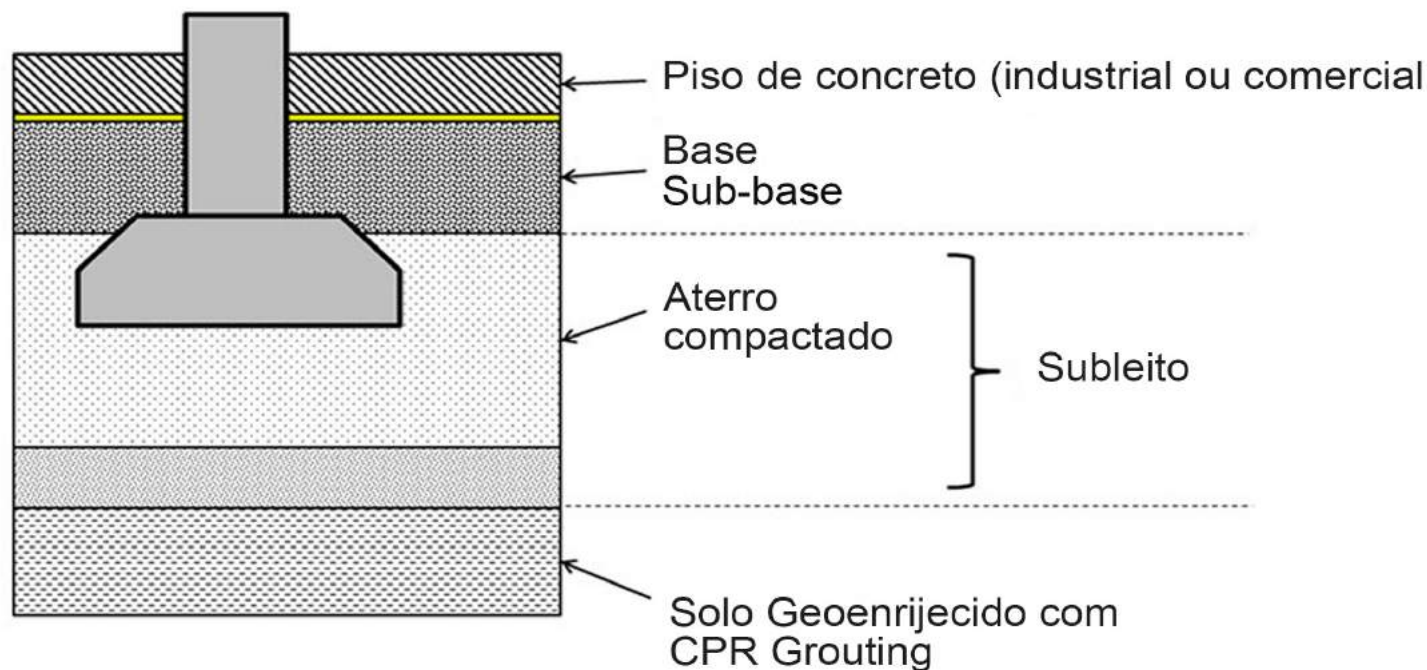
O solo mole, geoenrijecido com CPR Grouting, fica apto a receber as cargas do aterro e, a seguir, do pavimento e da estrutura sem qualquer deformação diferencial.
